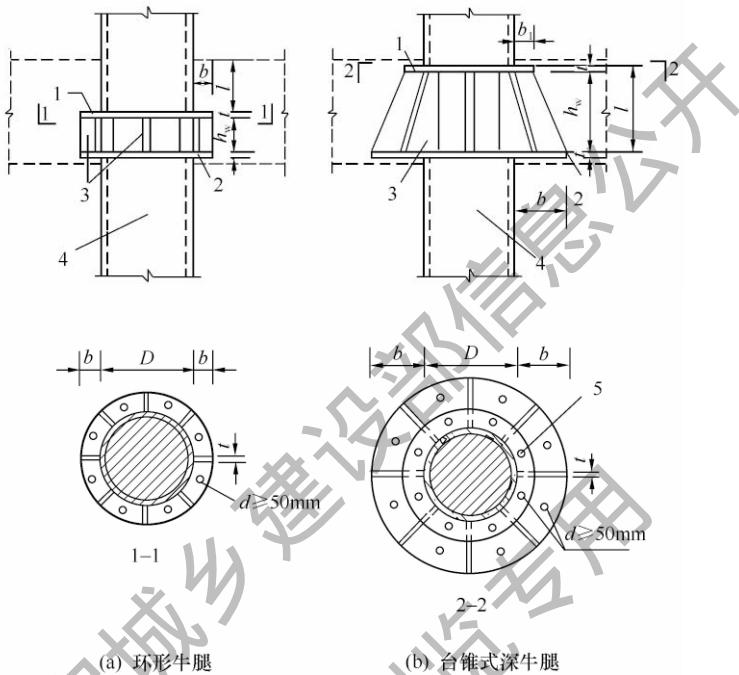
环形牛腿、台锥式深牛腿构造
